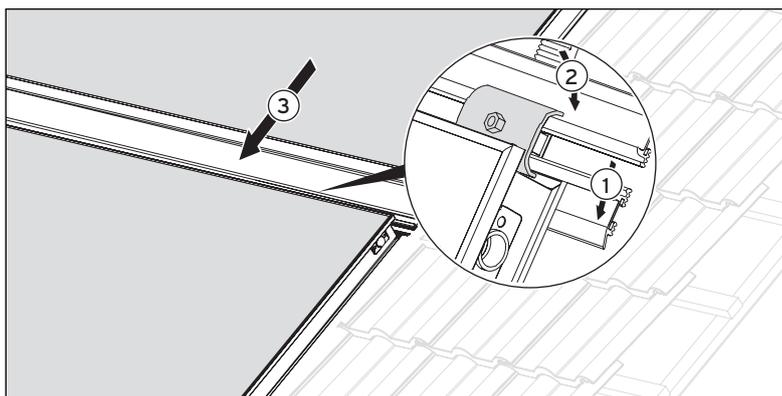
Guida di montaggio centrale (disposizione sovrapposta del campo)
